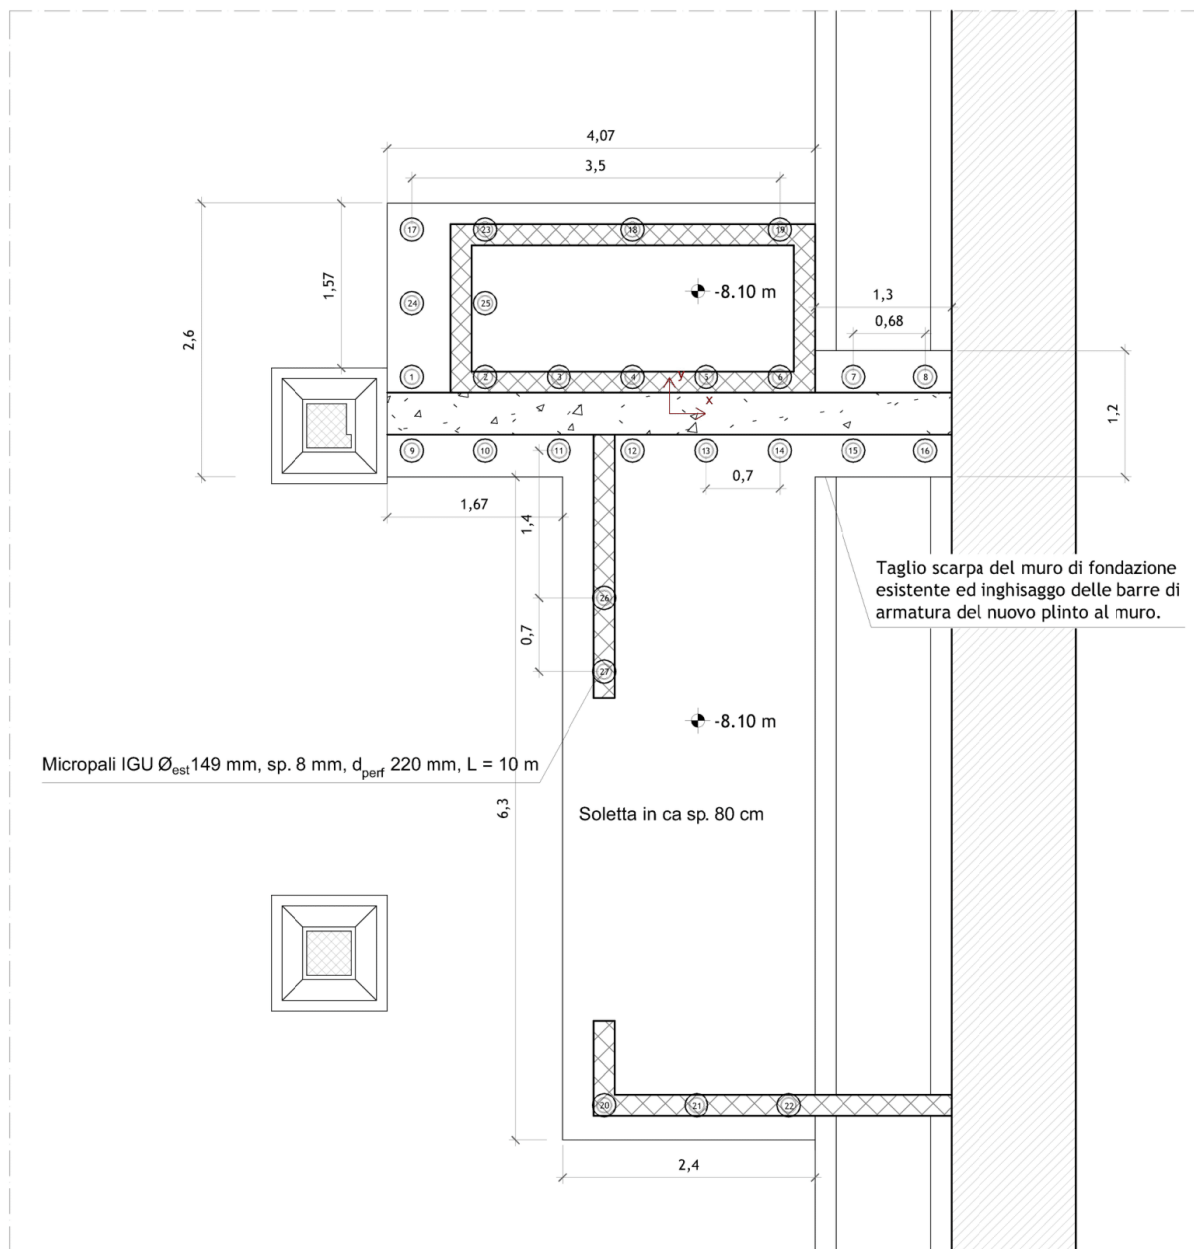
Disposizione planimetrica dei micropali - setto PET.
